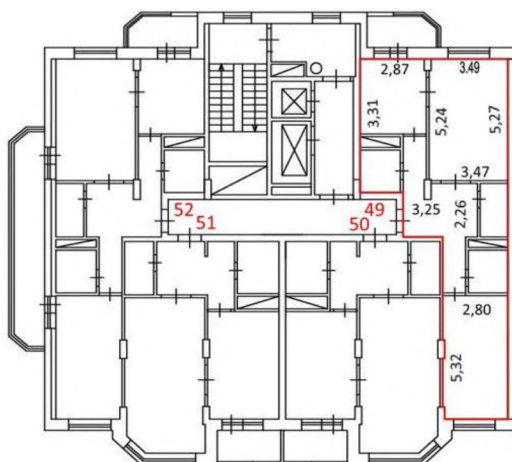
План секции 7-го этажа с квартирами 49–52
